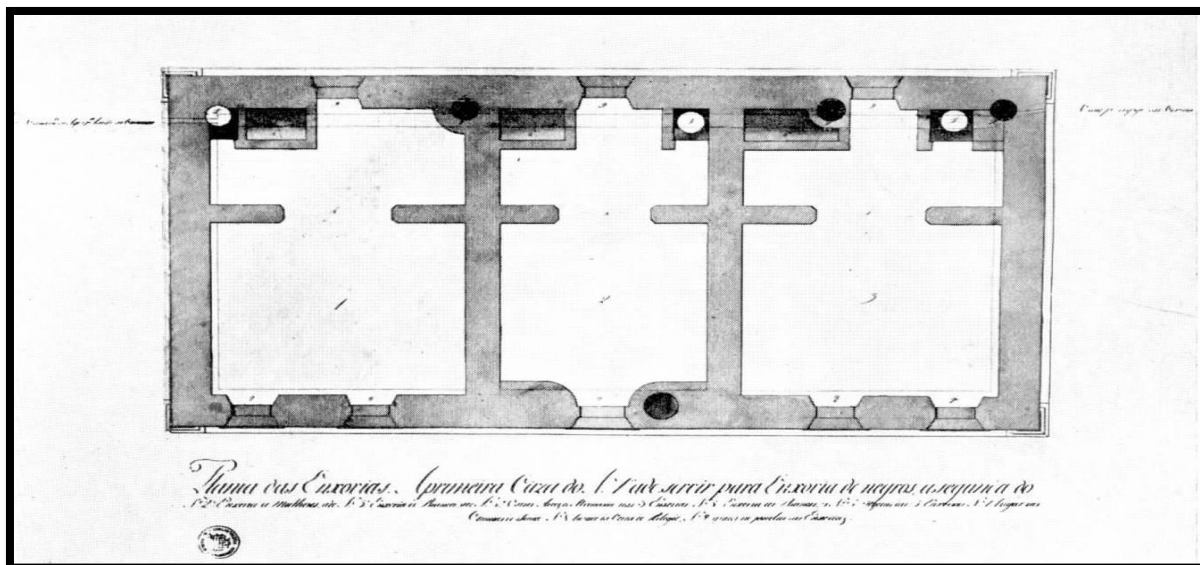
Planta baixa da antiga Casa de Câmara e Cadeia de Mariana.<sup>20</sup>
